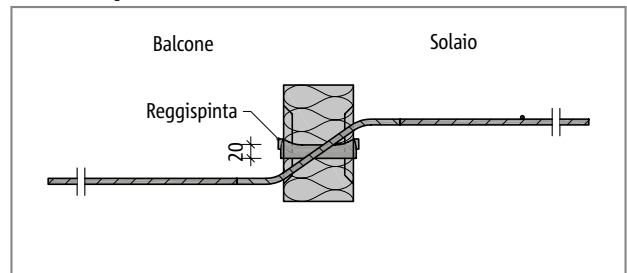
Schöck Isokorb® tipo da QXT60 a QXT90: sezione dell'elemento
